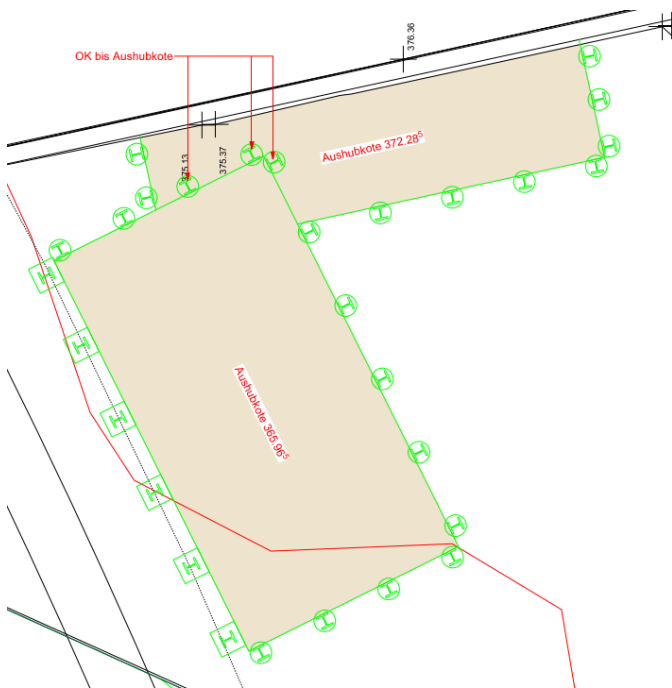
Grundriss der geplanten Aushubbereiche mit Rühlwandträger
